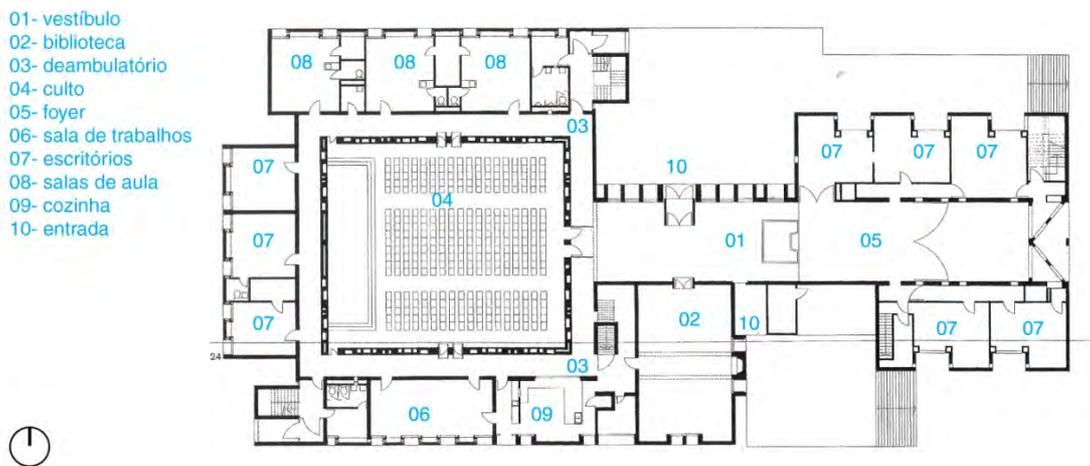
| Planta baixa First Unitarian Church [McCARTER]
